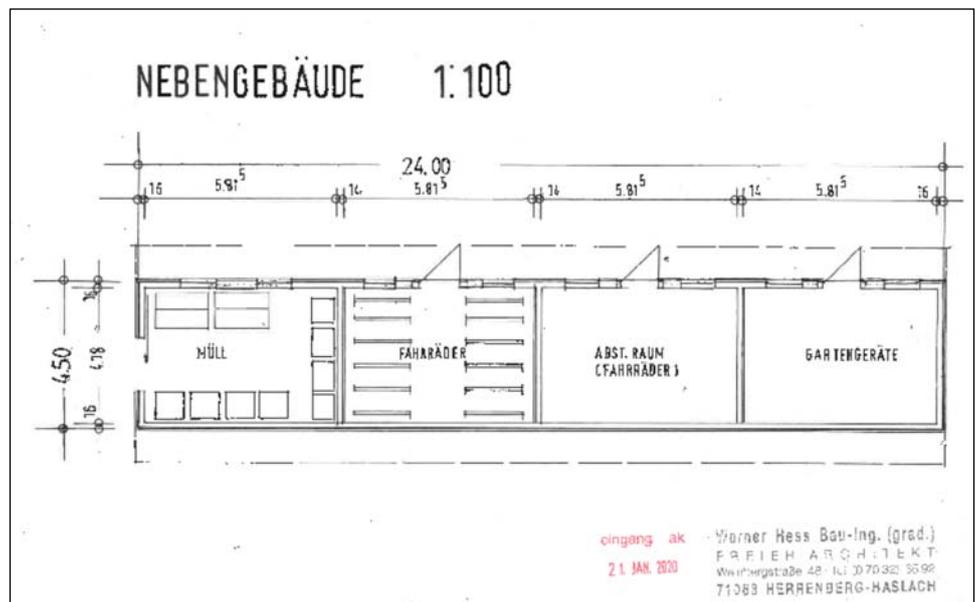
Grundriss Nebengebäude – Digital Hotel
